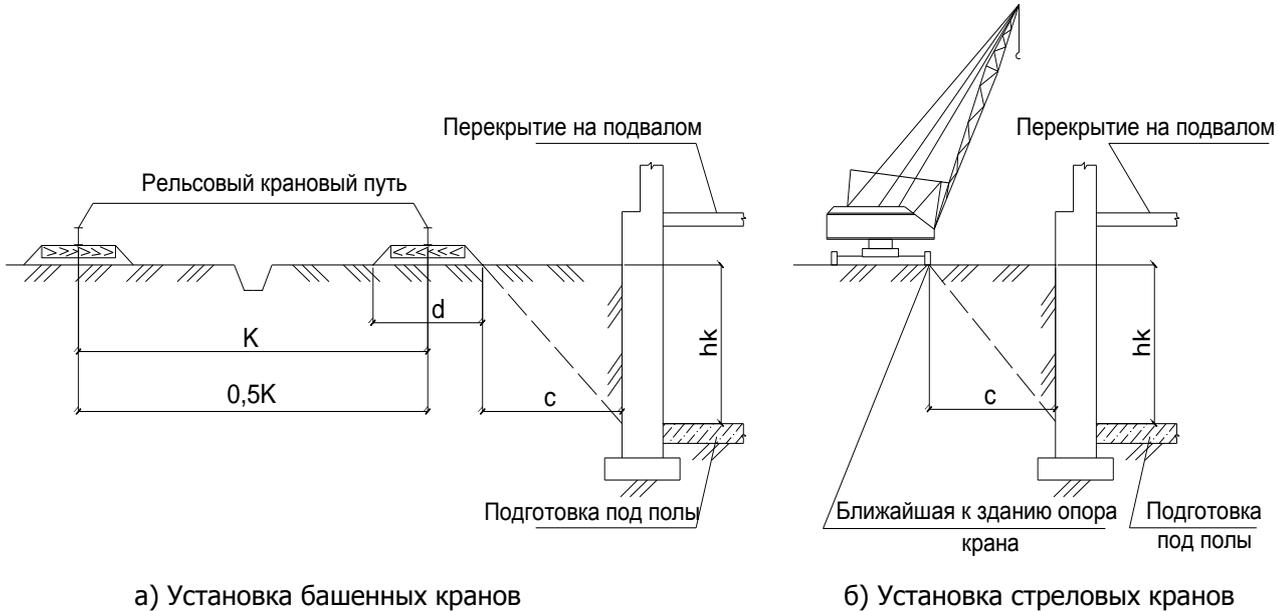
Установка башенных кранов (а) и стреловых (б) у зданий с подвалом без расчета выдавливания стен от крановых нагрузок
